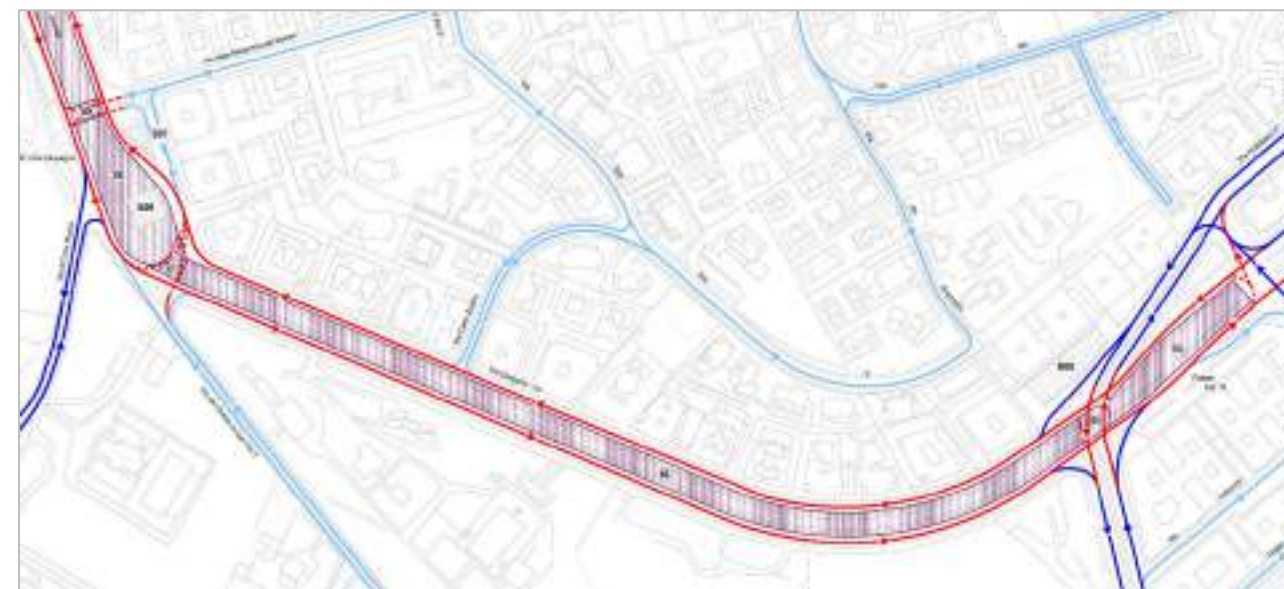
Schema circolazione di cantiere seconda macro fase: zona Piazza Pio XI – Piazza di Villa Carpegna
